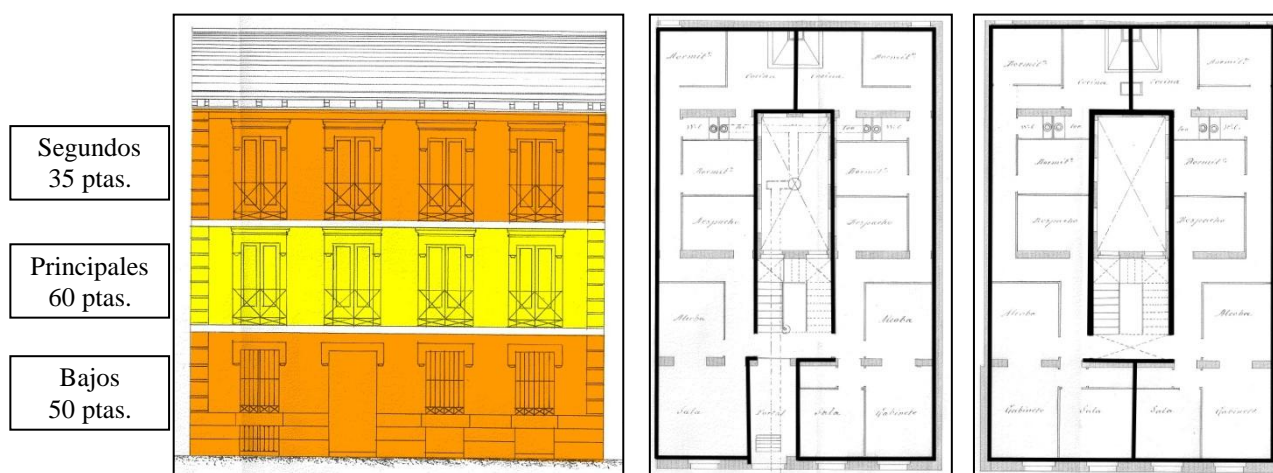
Plano de la fachada, planta baja, principal y segunda de la casa de alquiler, propiedad de José Verdú Gallo, erigida en 1904 en el nº 84 de la calle Lagasca. AVM, Secretaría, signatura 14-441-9.
